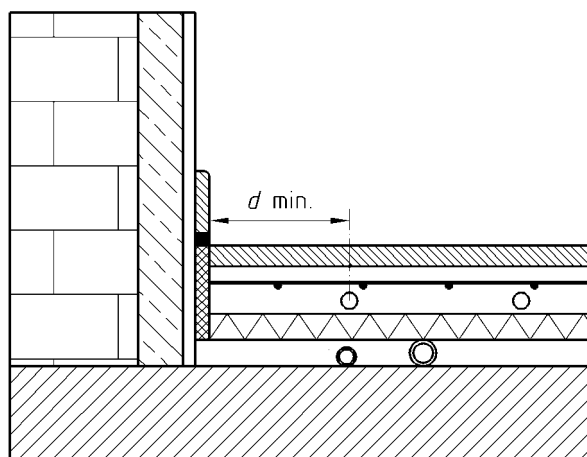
Coupe de plancher — Cotes et épaisseurs
